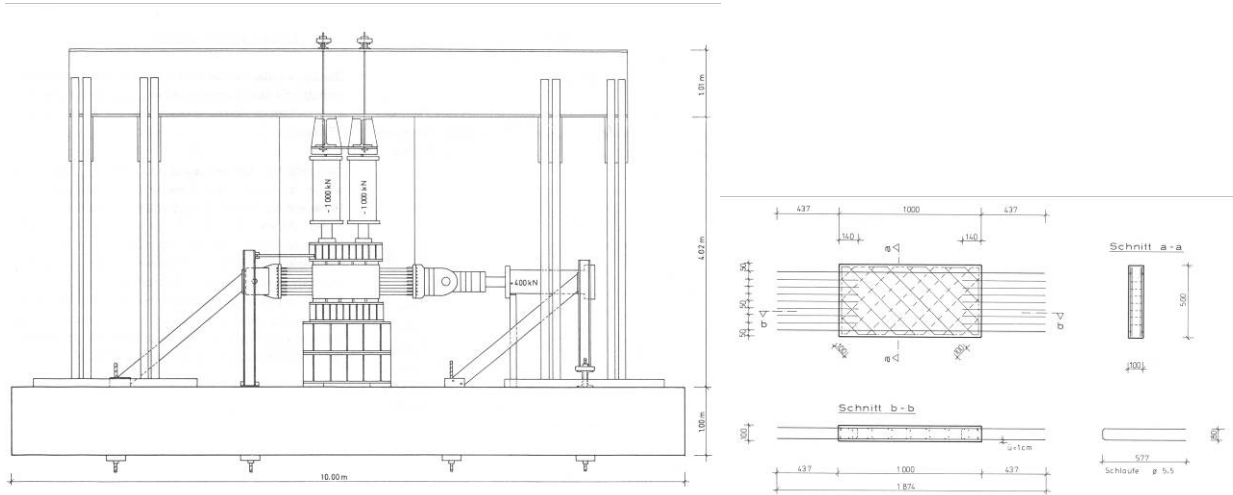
Versuchsaufbau (links) und Bewehrung (rechts) nach Kolleger & Mehlhorn [14]
